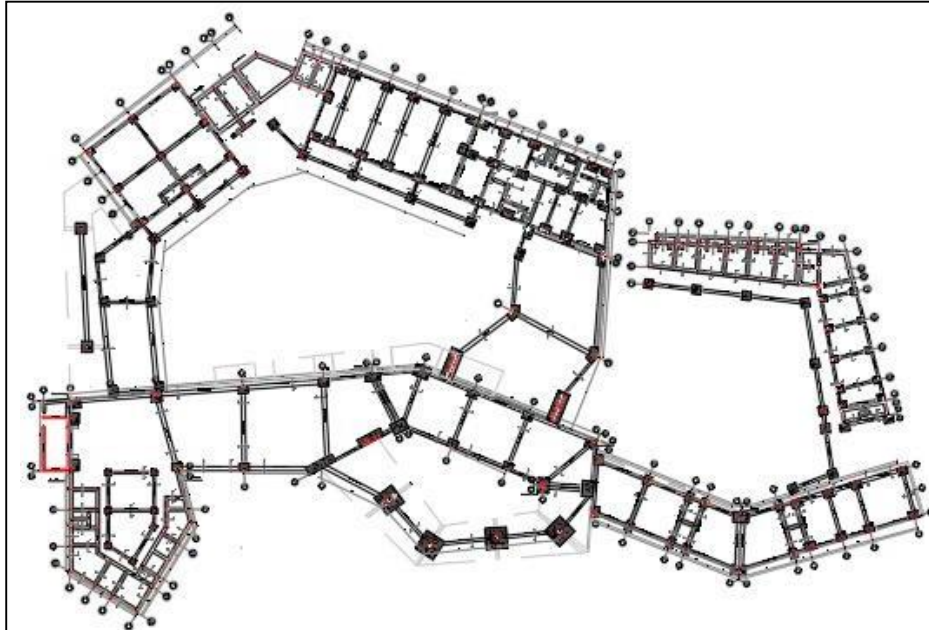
PLANO POR BLOQUES, SEGÚN NIVELES – CENTRO DE INTERPRETACION Y EDUCACIÓN AMBIENTAL
